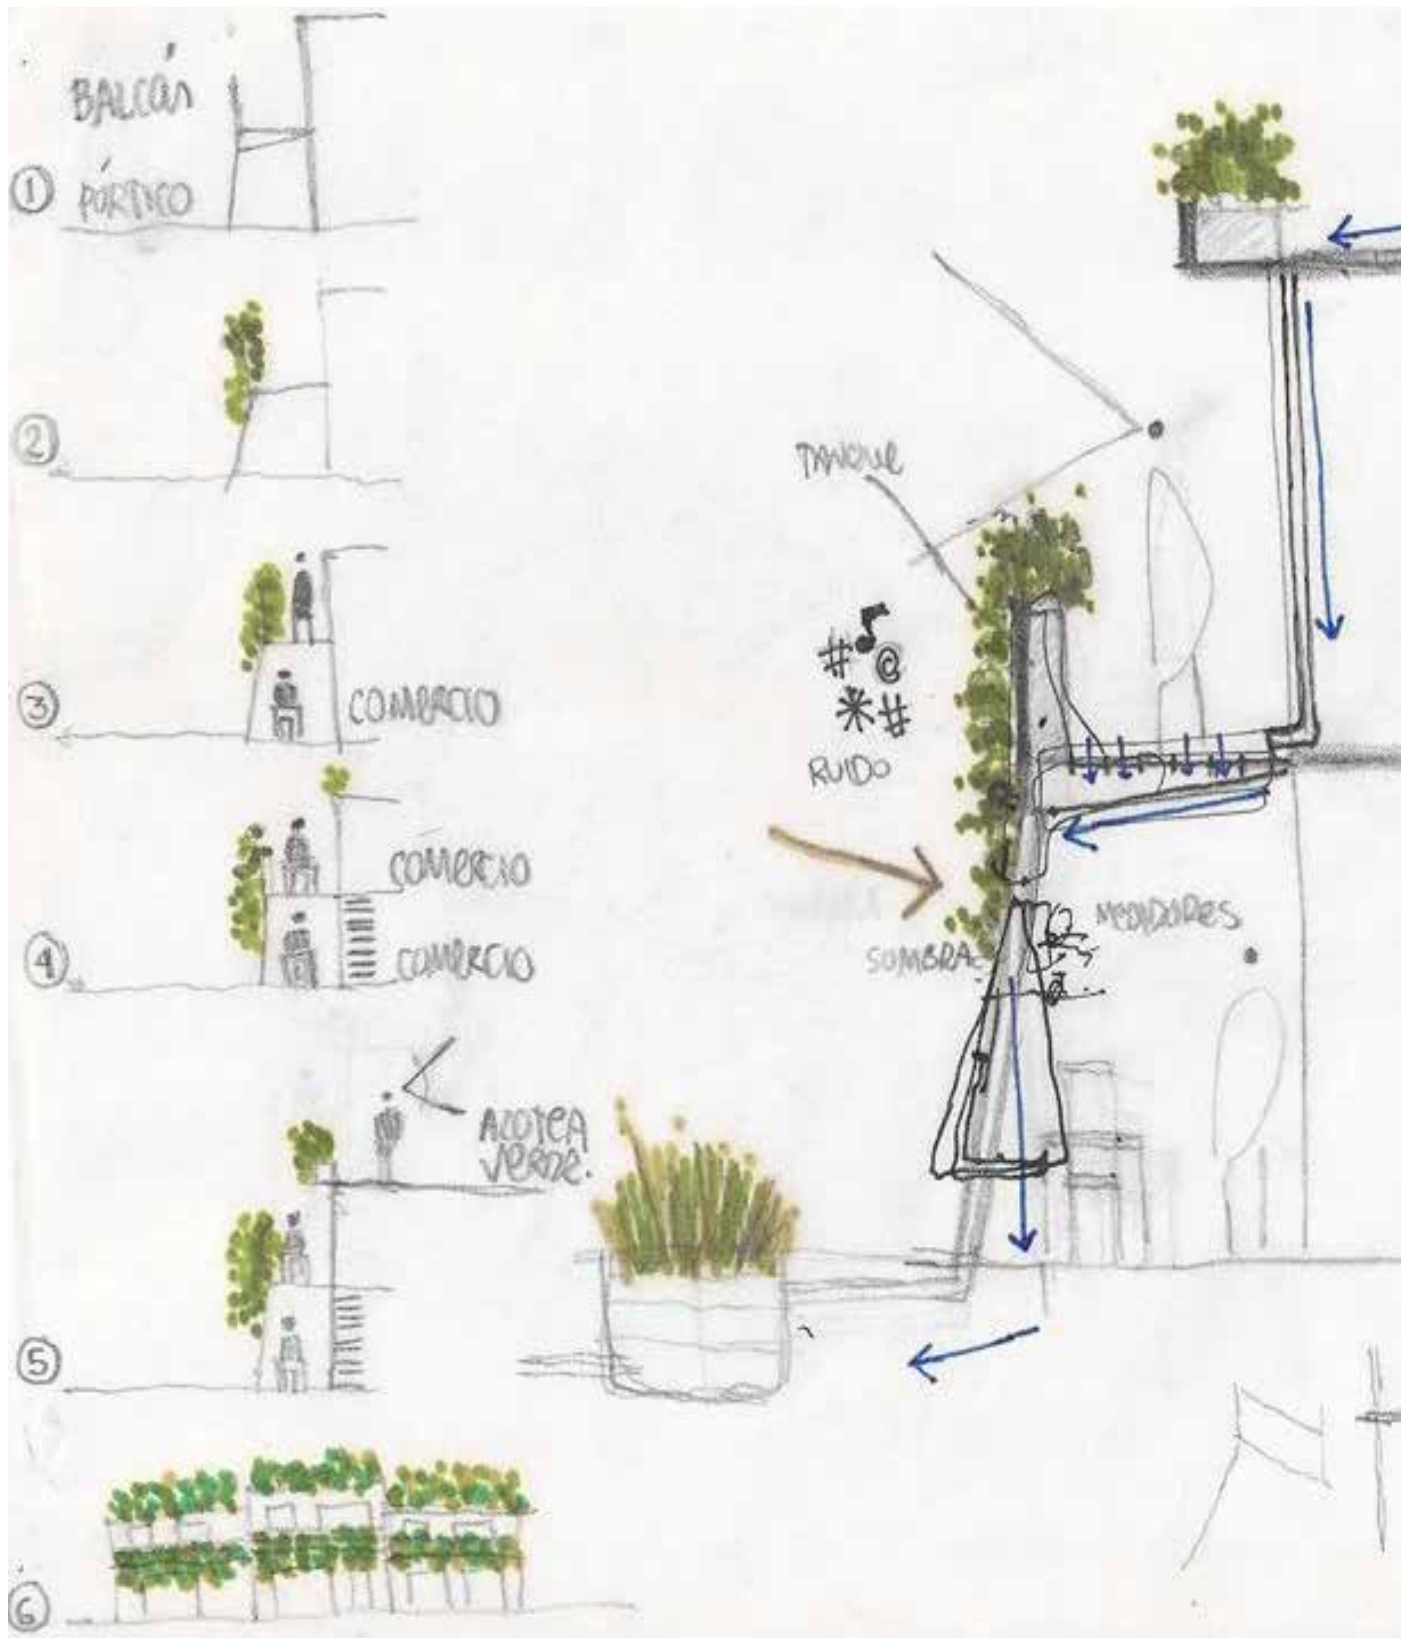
Croquis de las etapas de desarrollo del balcón / pórtico
